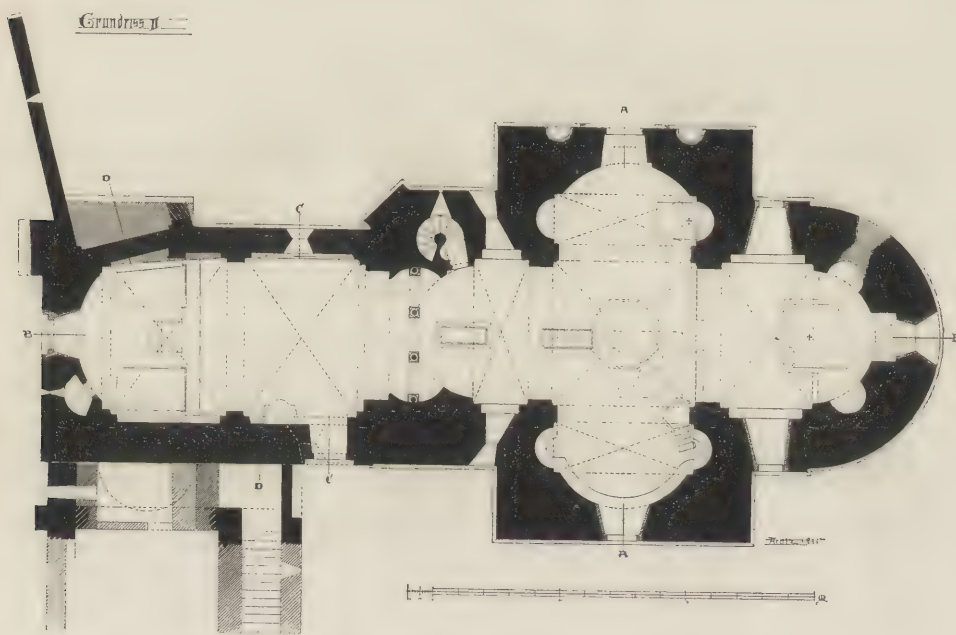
Haupt-Grundriss der Unterkirche.
